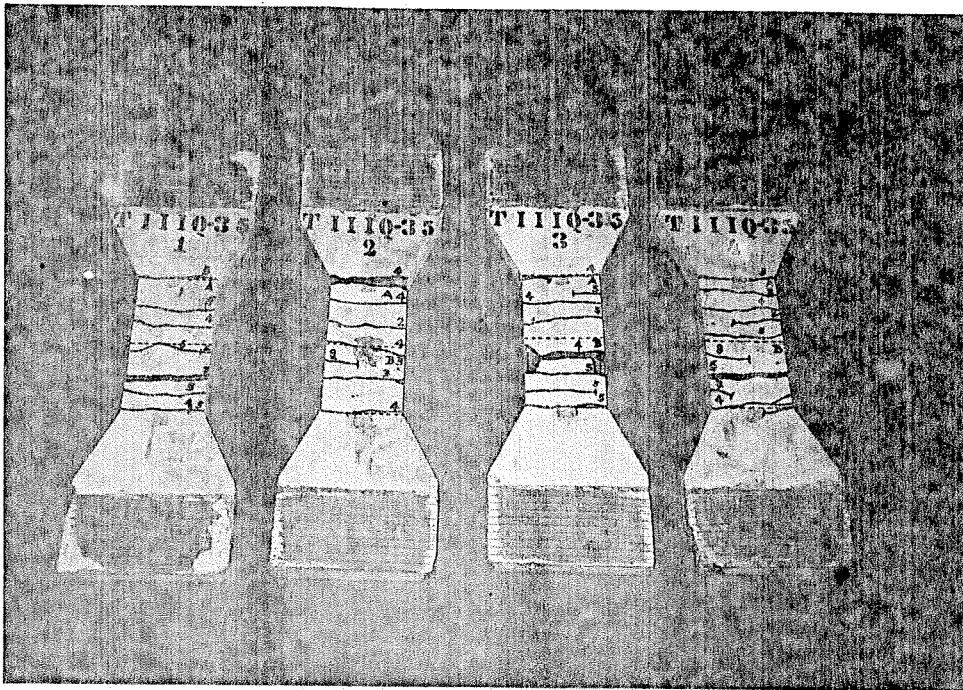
Fissuração final - Série T111035 (face 1 - regiões A e B)
